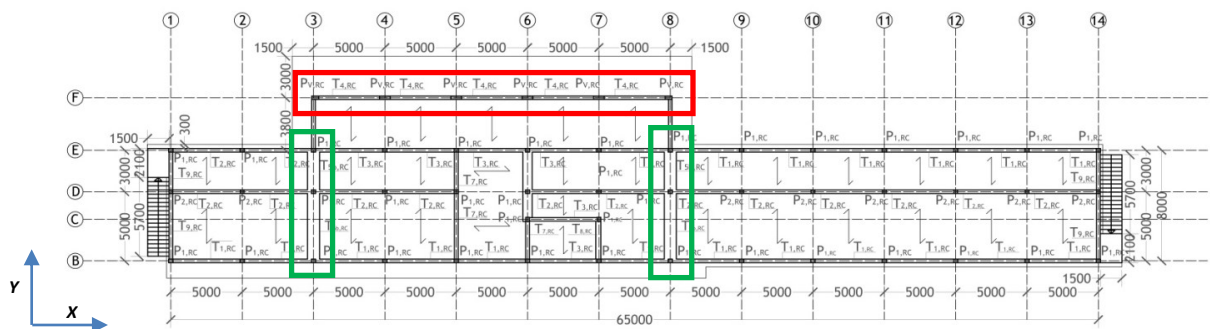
Pianta del piano terra con denominazione delle travi e dei pilastri; localizzazione dei pilastri a sezione variabile, racchiusi nel rettangolo in rosso, e di quelli posti lateralmente rispetto al balcone, nel rettangolo verde
